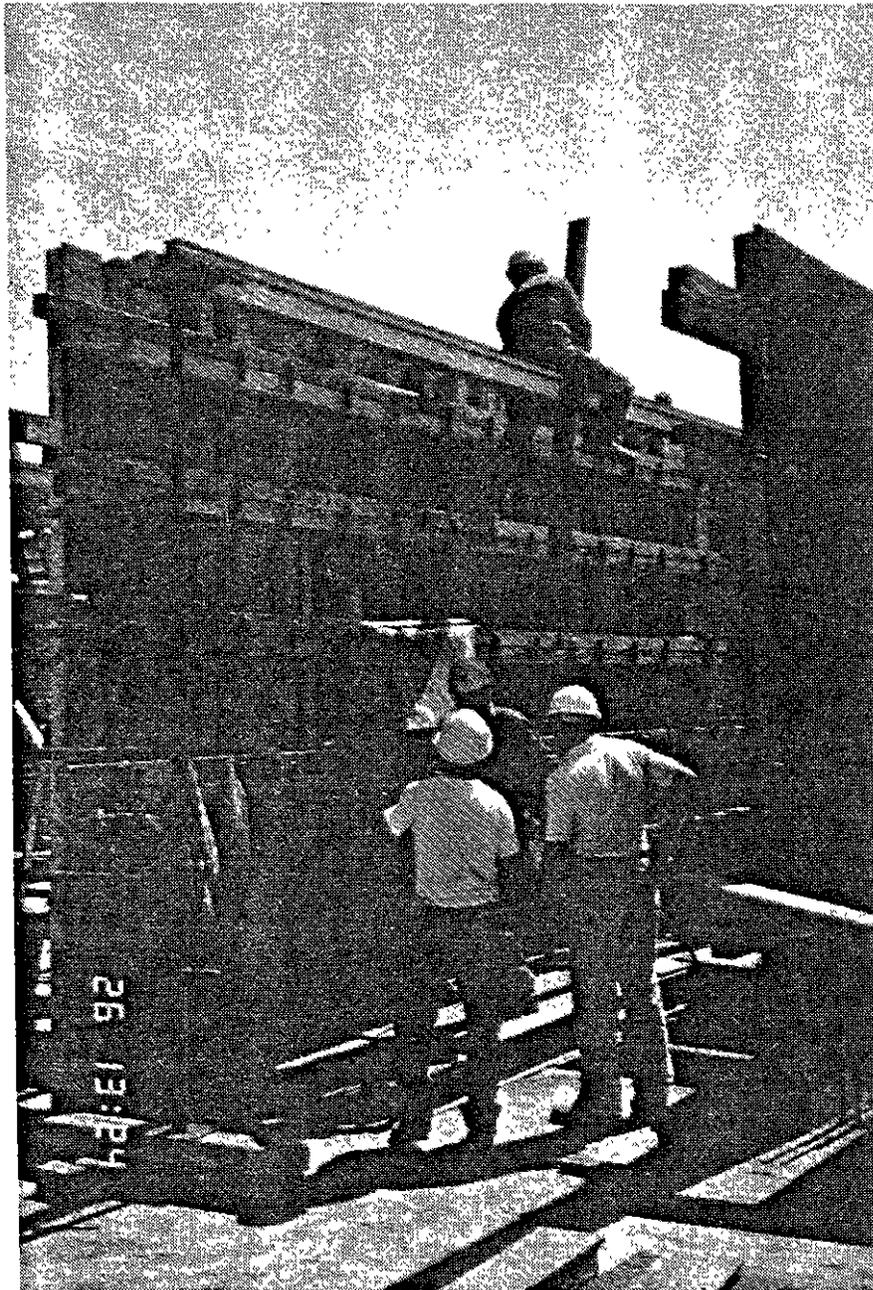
FIXATION D'UNE PLANCHE SOUS LE LONGERON PAR LE
